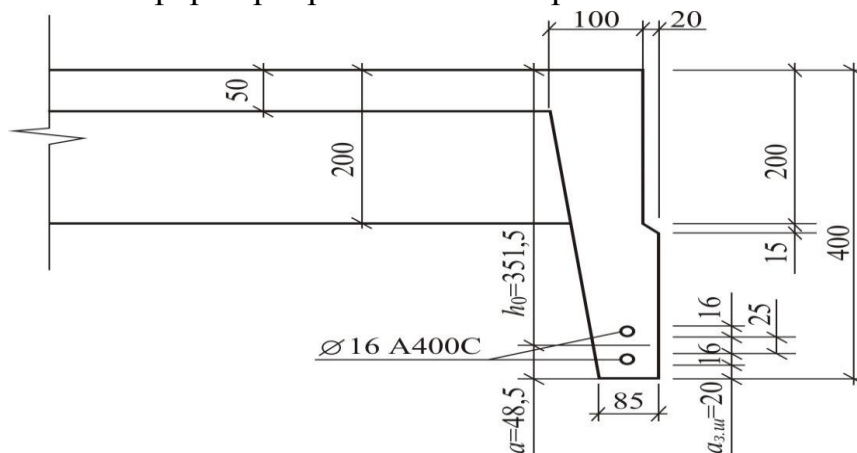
Розташування робочої арматури в поздовжньому ребрі плити.
